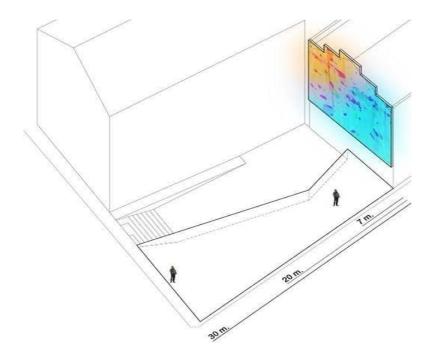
écran dynamique sur la façade ouest du Bloc D/ Source : archidaily.
